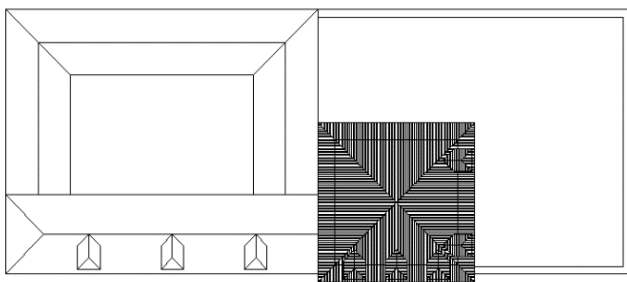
“Planta de Cobertura – Torreão Norte.”
